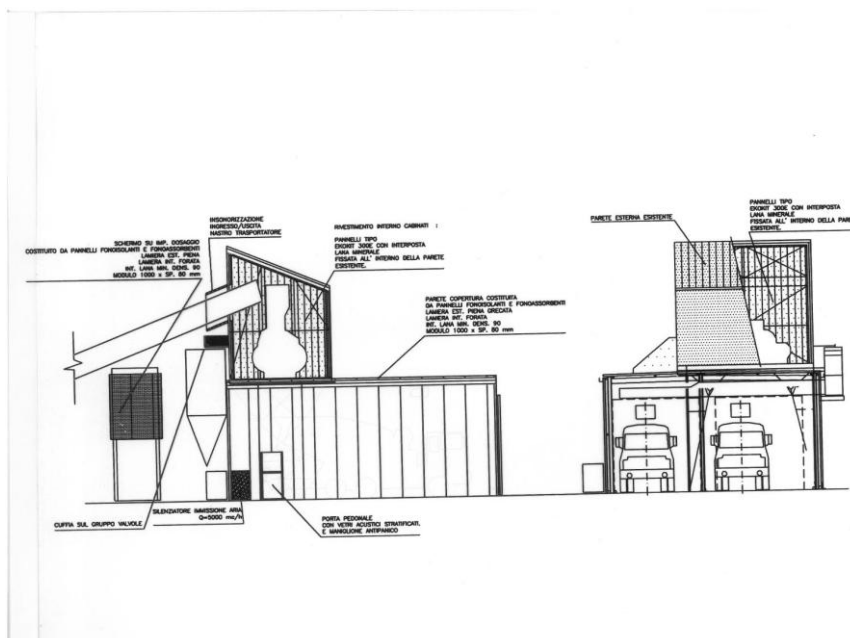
Sezione insonorizzazione impianto di betonaggio
